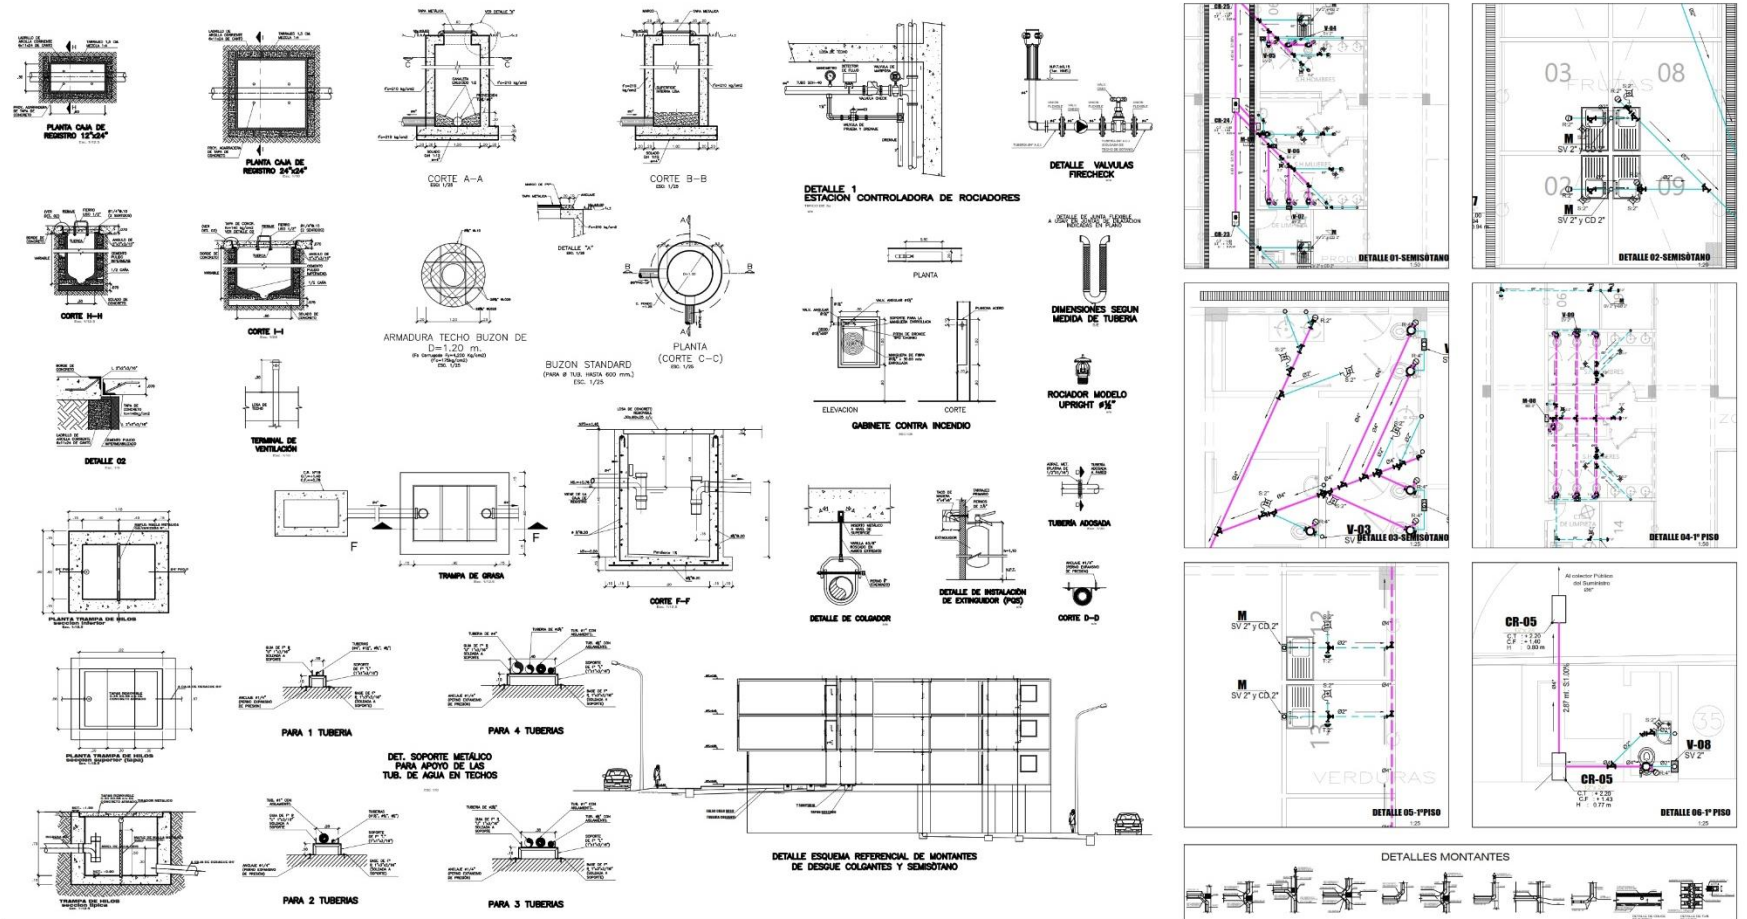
Plano de instalaciones sanitarias-red de desagüe (Detalles)
